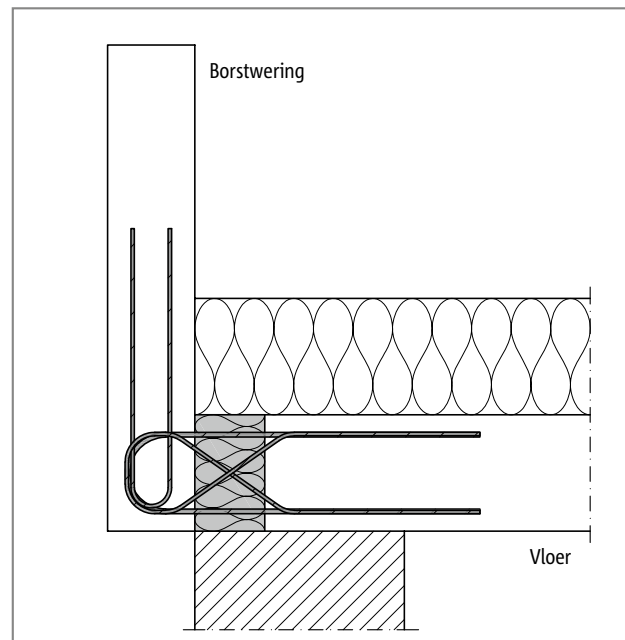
Schöck Isokorb® T type A: Aansluiting van een borstwering (type A-MM2-VV1)
